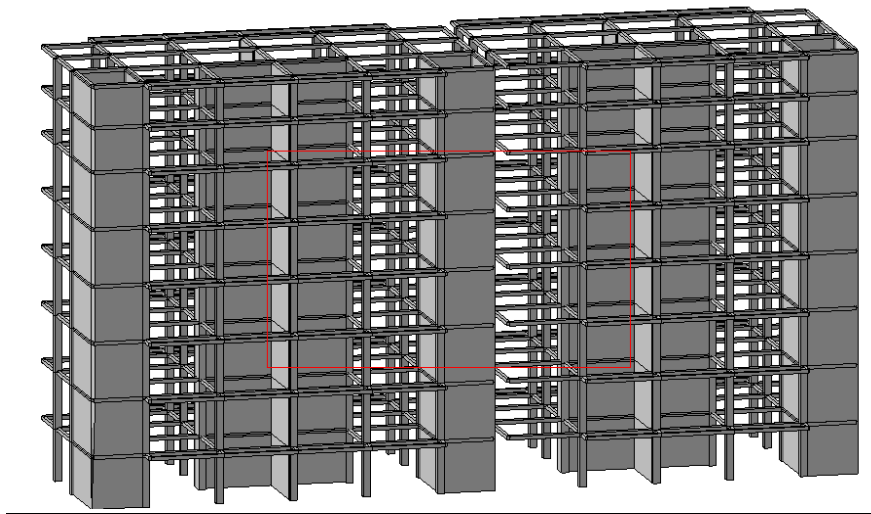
Розрахункова схема просторової рами з діафрагмами жорсткості
